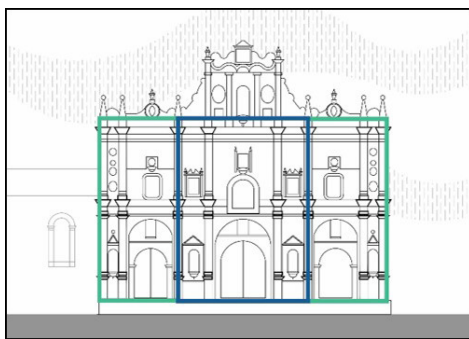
Calles de la Fachada. Fuente: Realizado por el autor.
